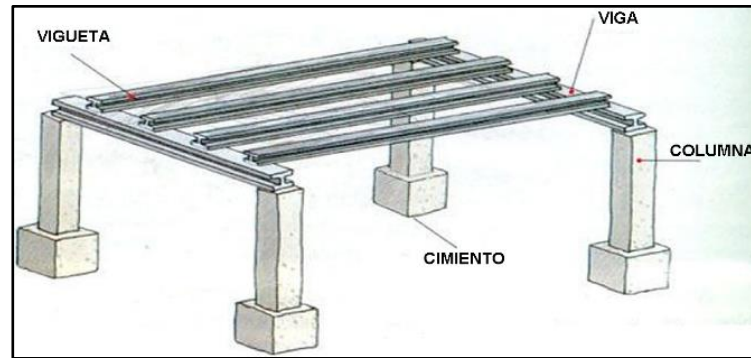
Elementos estructurales de una vivienda. Tecnología (2016)
